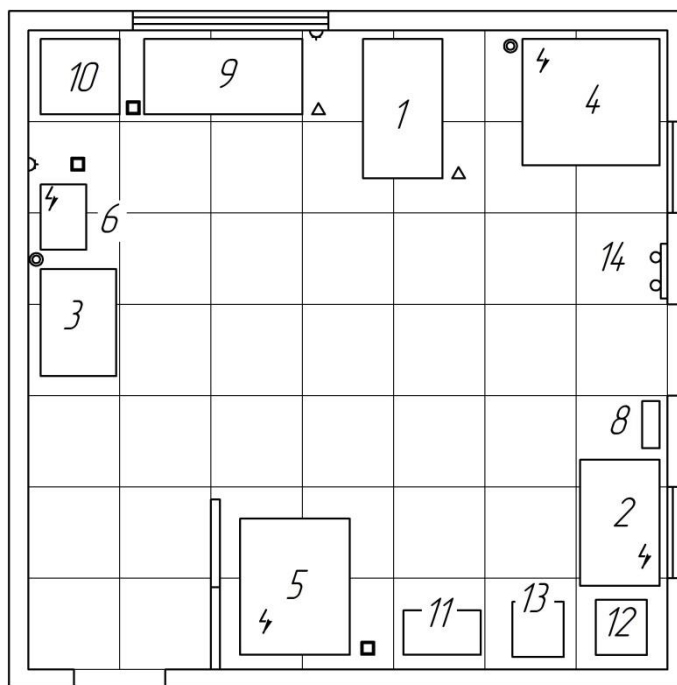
Планировка помещения: 1 - Шиномонтажный стенд с манипулятором; 2 - Балансировочный стенд; 3 - Ванна для проверки камер; 4 - Автоматическая мойка колес; 5 - Станок для правки дисков; 6 - Электровулканизатор; 7 - Подъемник в зоне ТО; 8 - Подкатной домкрат; 9 - Верстак; 10 - Шкаф для хранения расходных материалов; 11 - Ларь для хранения отходов; 12 - Колонка для накачки шин; 13 - Устройство для измерения биений; 14 - Пожарный щит
